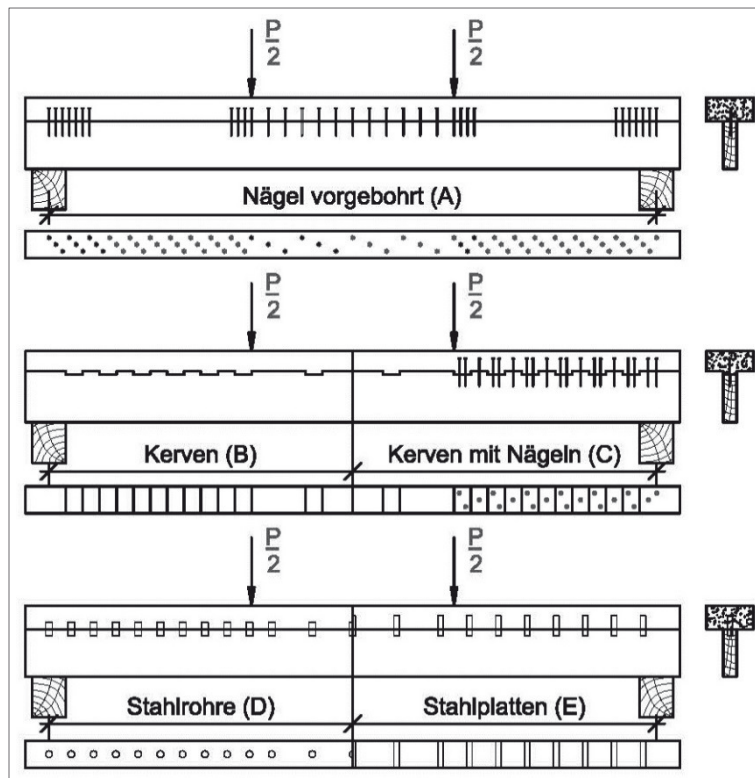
Probekörper der Forschungen nach [7] zu Holz-Beton-Verbundbrücken
